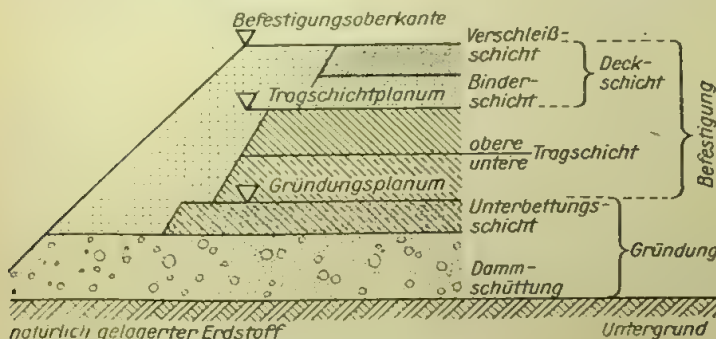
Konstruktionsschichten im Straßenbau
